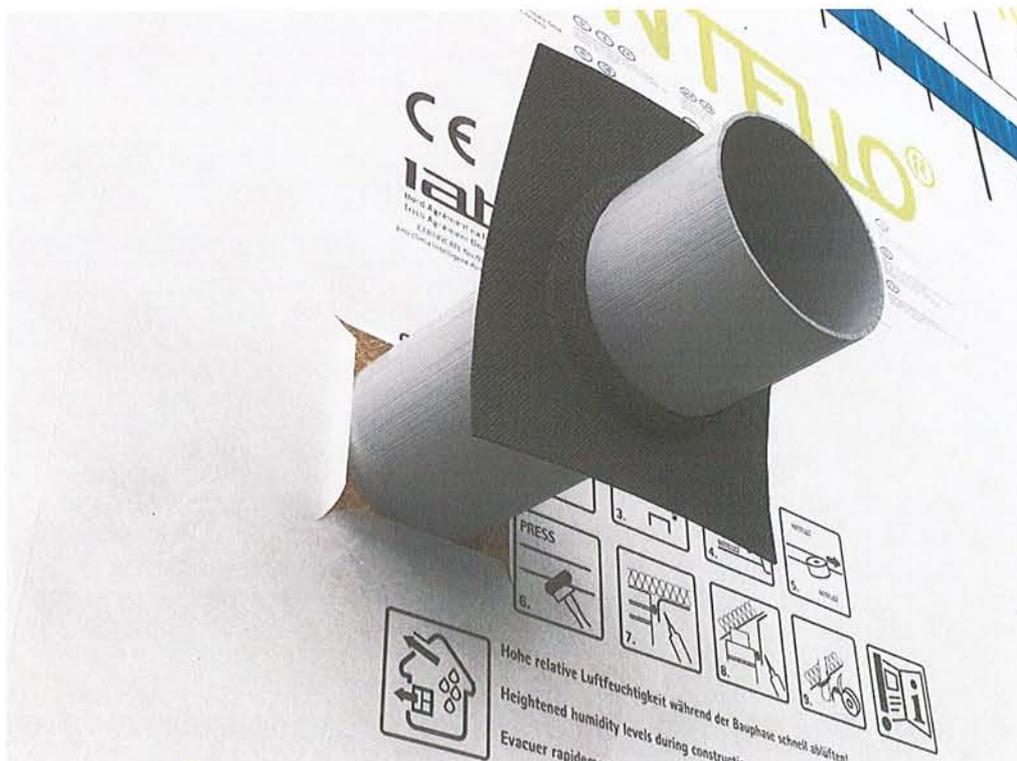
La manchette ROFLEX est à glisser sur le conduit
